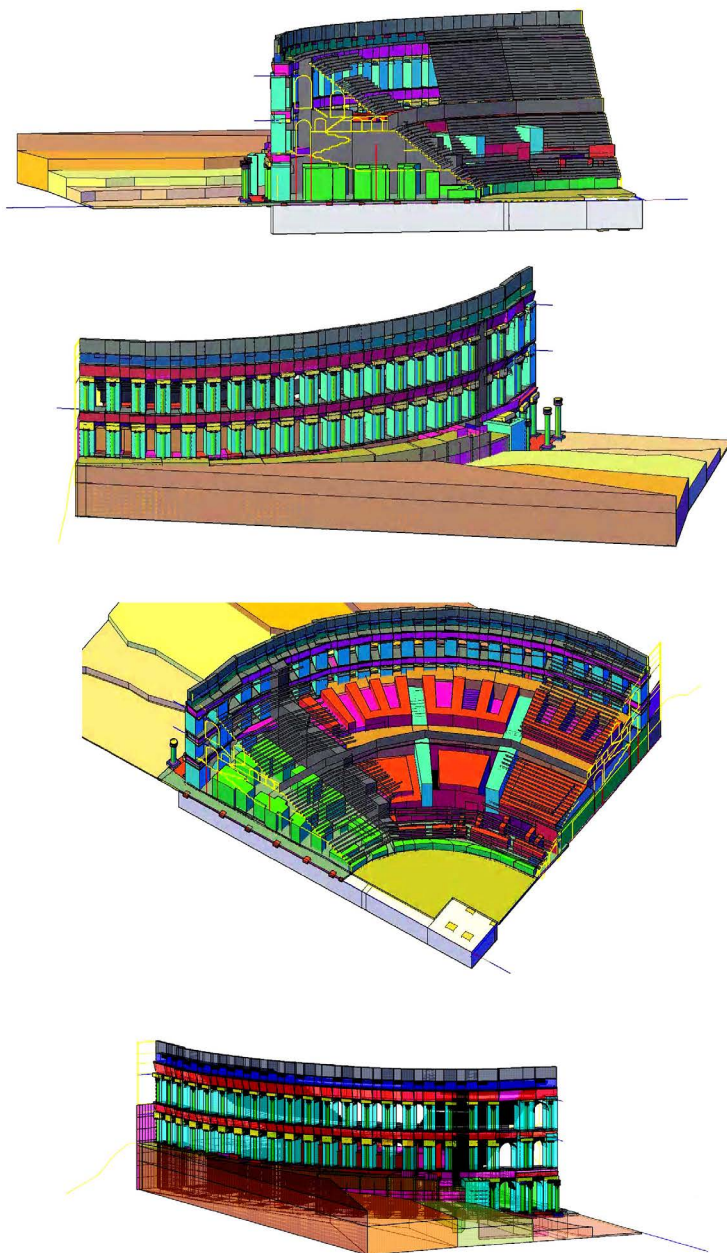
Digitalización de la planta y alzado del anfiteatro y restitución de las partes que faltan, apreciándose las propuestas para las fachadas principales porticadas, escalera perimetral por el interior del conjunto, y cuerpo intermedio de separación entre la segunda y tercera cávea.
